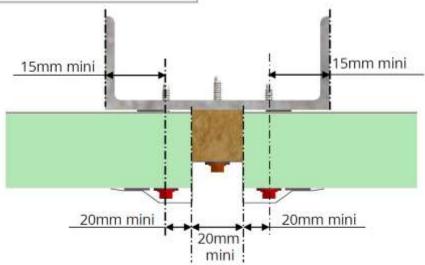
Répartition des fixations traversantes – Cas spécifiques d'une jonction verticale en pose horizontale avec panneaux posés sur 2 appuis et/ou en extrémité de panneau au droit d'un angle
